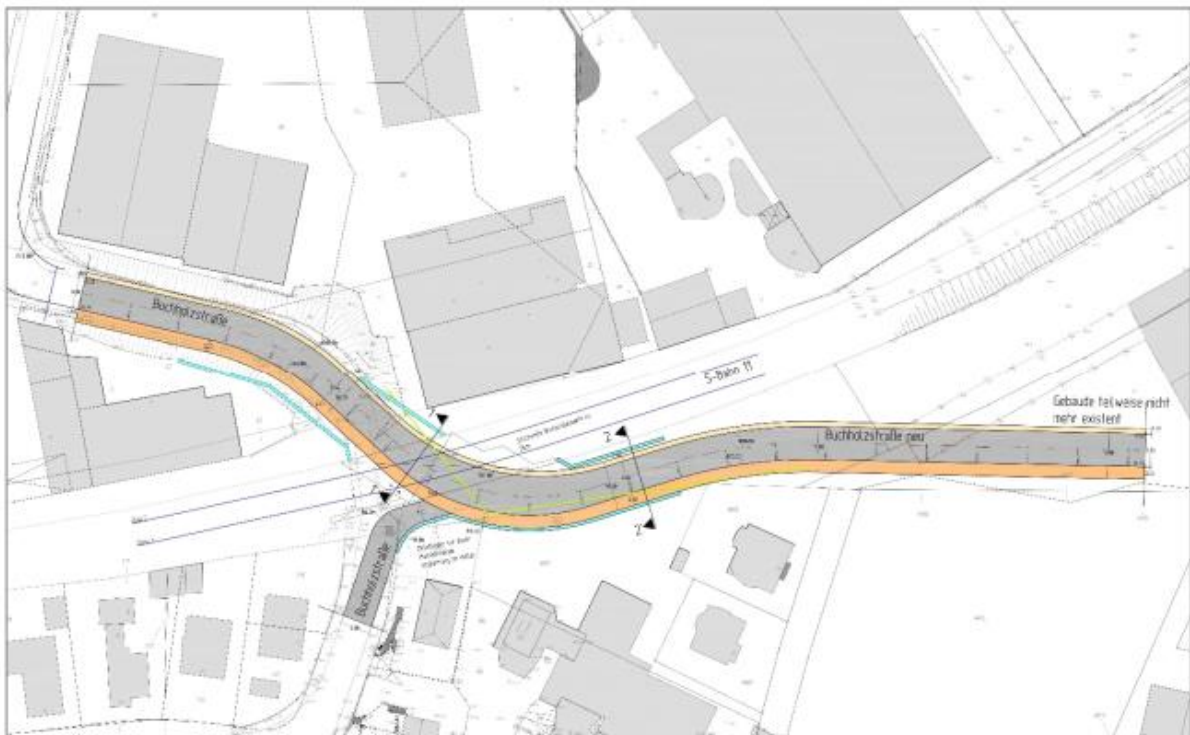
Straßenplanung im Bereich des Brückenbauwerks Buchholzstraße, VIA 2019
